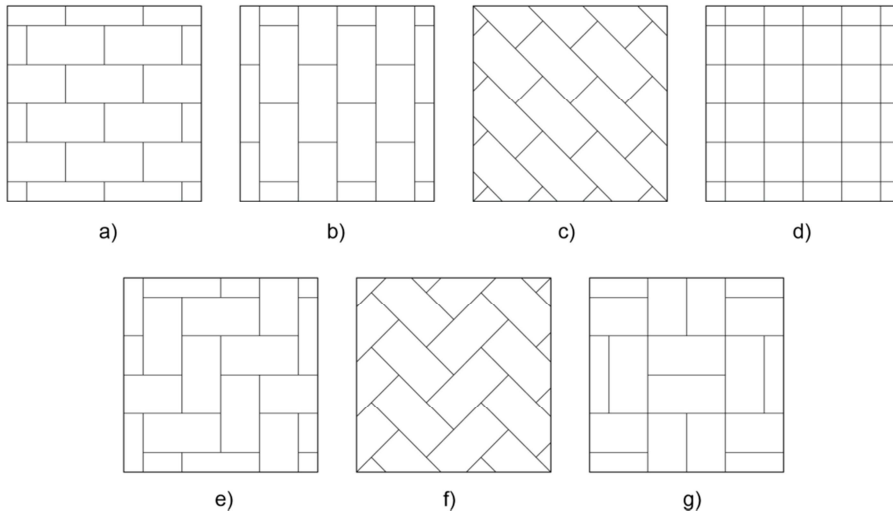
Apparecchiature tipicamente utilizzate per le pavimentazioni ad elementi autobloccanti in calcestruzzo: a) stretcher bond o a file parallele, b) running bond, c) diagonal bond, d) stack bond, e) ed f) herringbone bond o a spina di pesce e g) basketweave bond.
